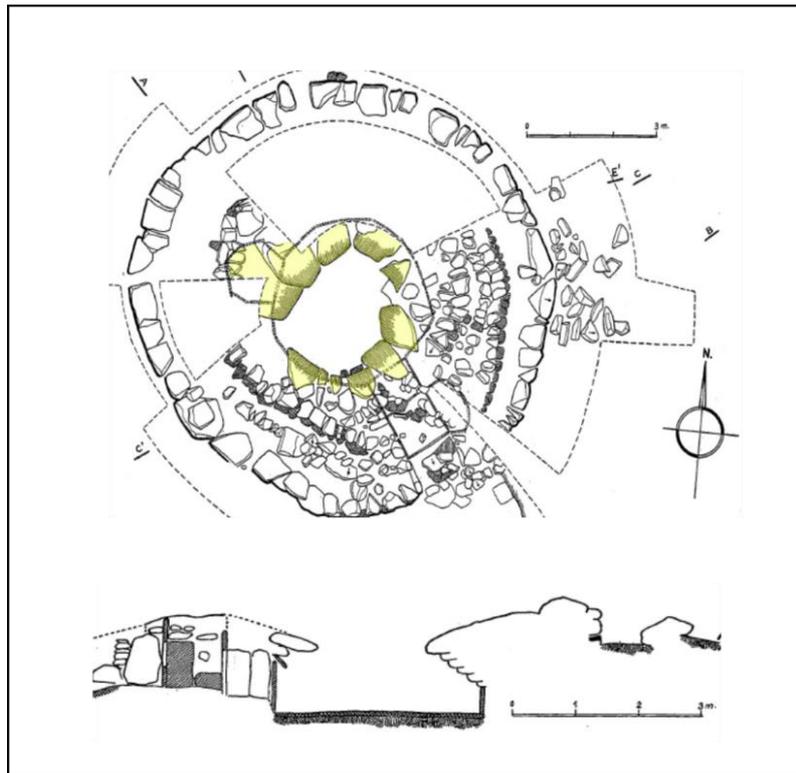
Planta y alzado de Los Millares XXI donde se observa el arranque de la falsa cúpula a base de ortostatos planos horizontales (Almagro y Arribas, 1953)
